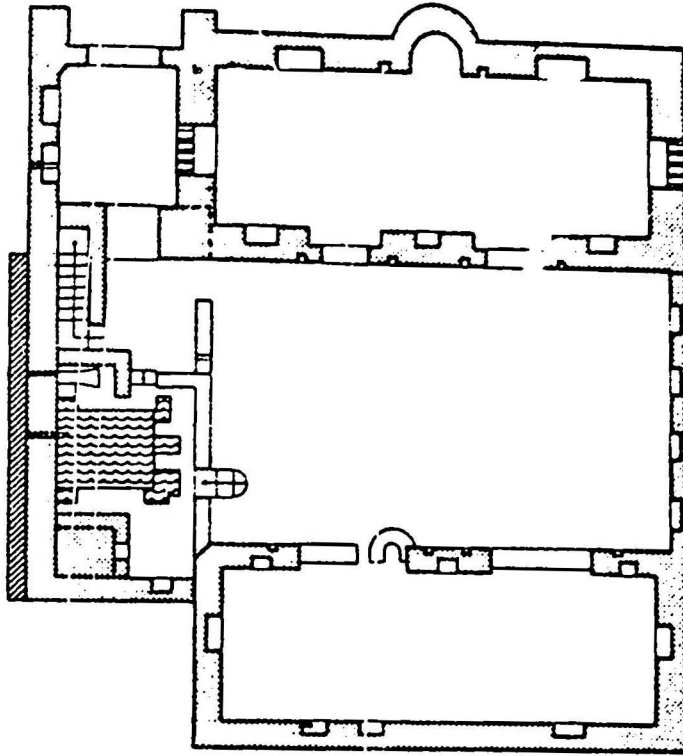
مسقط أفقي للمدرسة المعتبية - تعز
